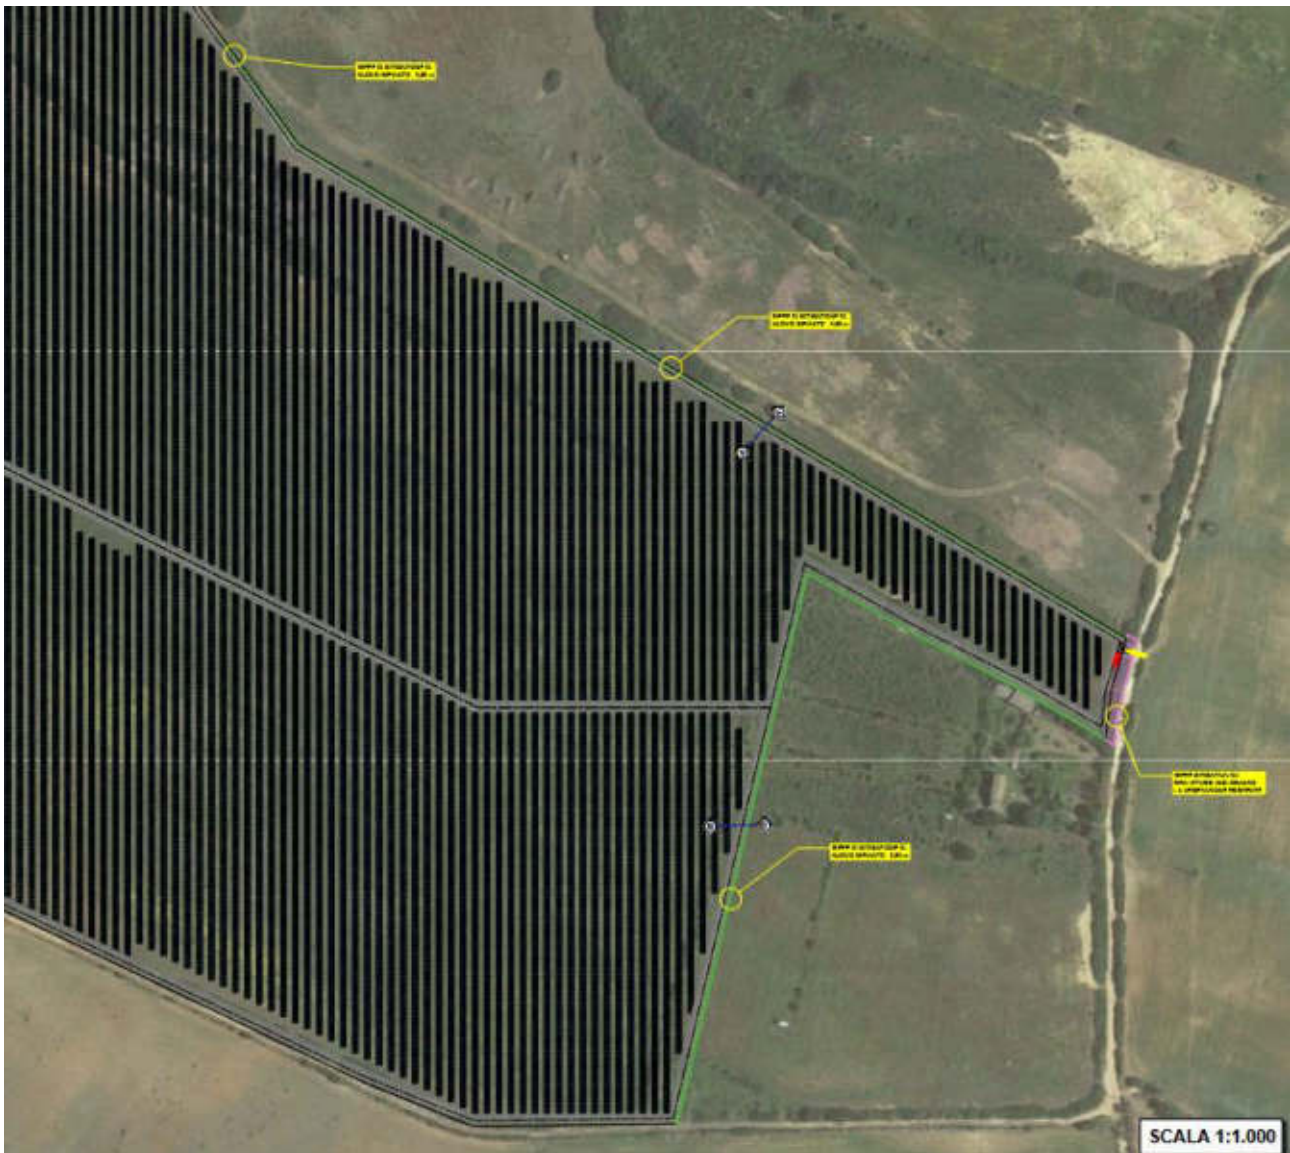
Estratto della Tavola raffigurante La planimetria delle mitigazioni a verde in progetto nel lotto 1 (DTG-0039)
